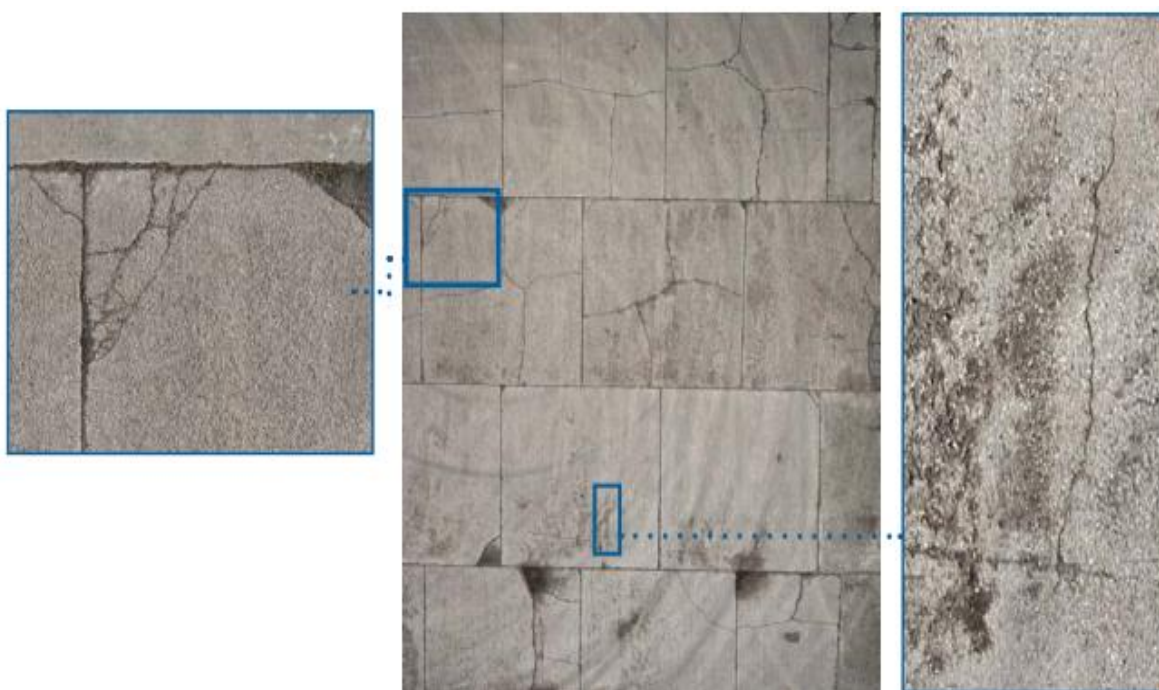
Inspeção Área de Movimento - Pavimento Rígido
